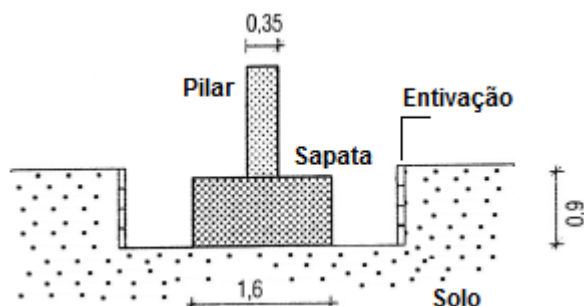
Escavação e entivação da zona da sapata [adaptado de 86]
